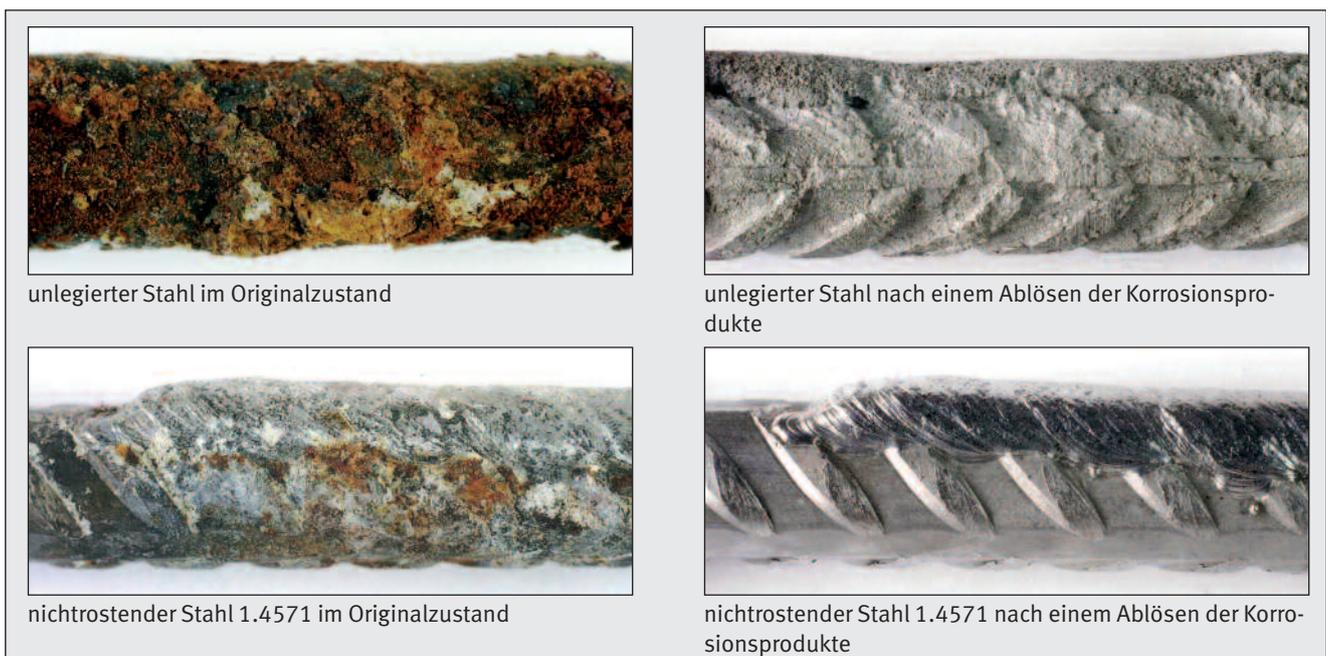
Korrosionszustand von kaltumgeformten Betonrippenstähle nach 2,5 jähriger Lagerung in gerissenem Beton (Betonriss von 0,4 mm Breite kreuzte die Stähle etwa in Bildmitte); der Chloridgehalt betrug nach Abschluss der Versuche etwa 5 M.-% bezogen auf den Zementgehalt [16]
